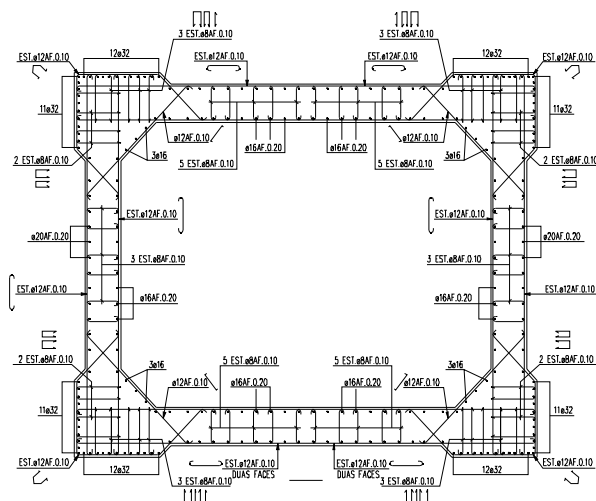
Armadura longitudinal e transversal dos pilares P1, P2 e P3.
